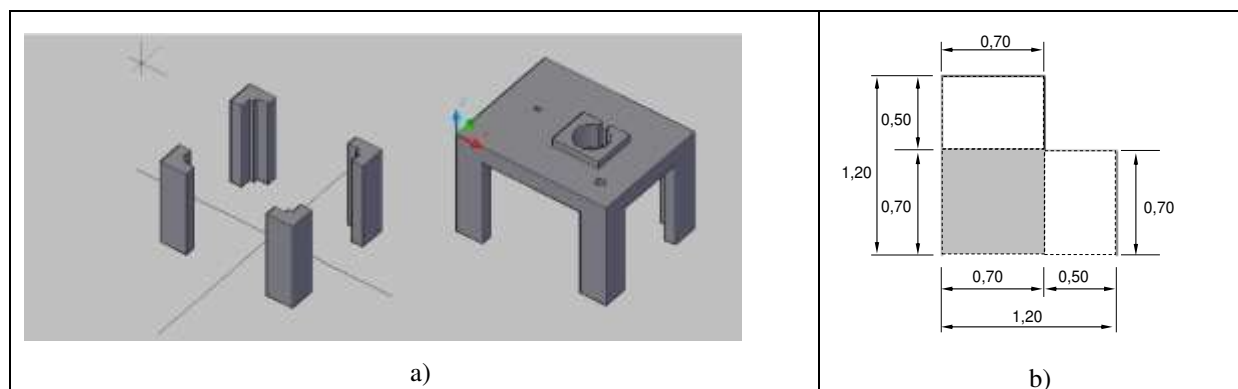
a) Vista general de los refuerzos planteados en las columnas de esquina; b) Refuerzo en las columnas.
